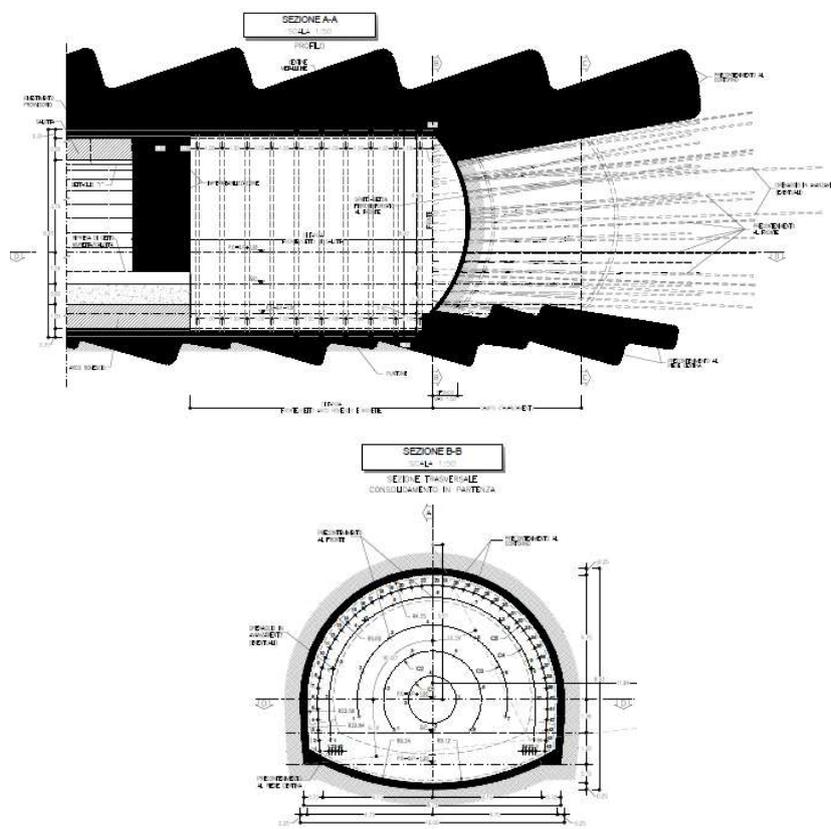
Sezione tipo C2p bypass area di sicurezza
